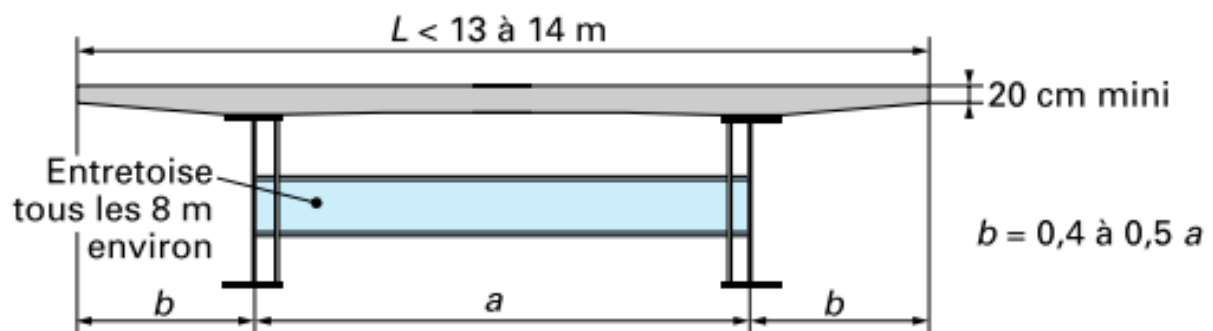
Profil en travers d'un bipoutre à pièces de pont.
